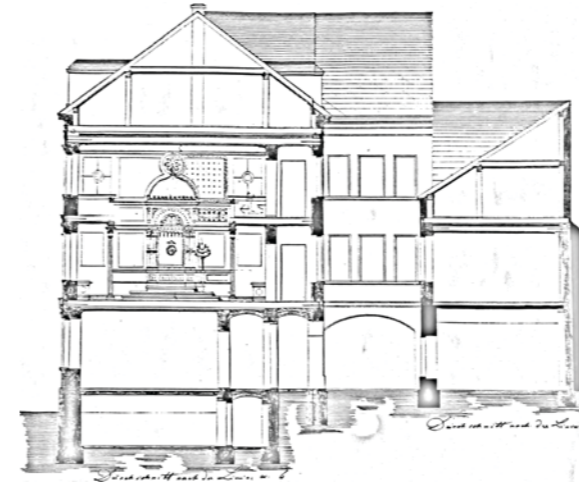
rechts: Stadtplan mit der Lage des Betraumes (1) und der Lage des Synagoge (2); Abb. 14 oben: Schnitt durch den Betraum
